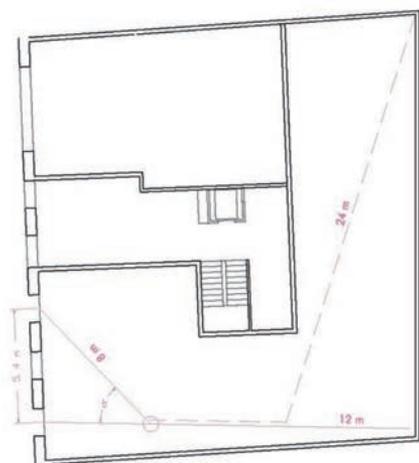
Planta establecimiento venta con detalle dos puertas de salida.
